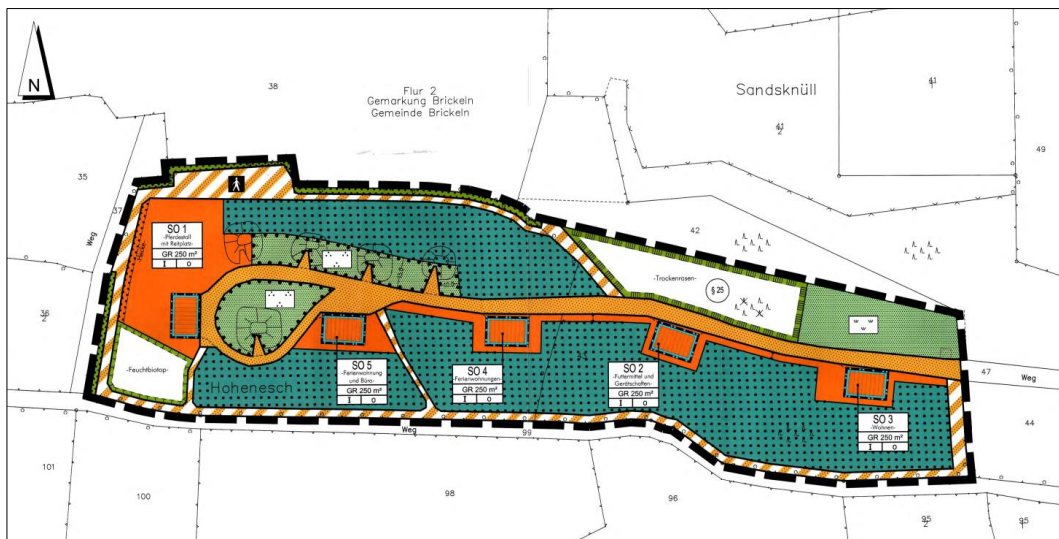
Ausschnitt 1. Änderung B-Plan Nr. 2
